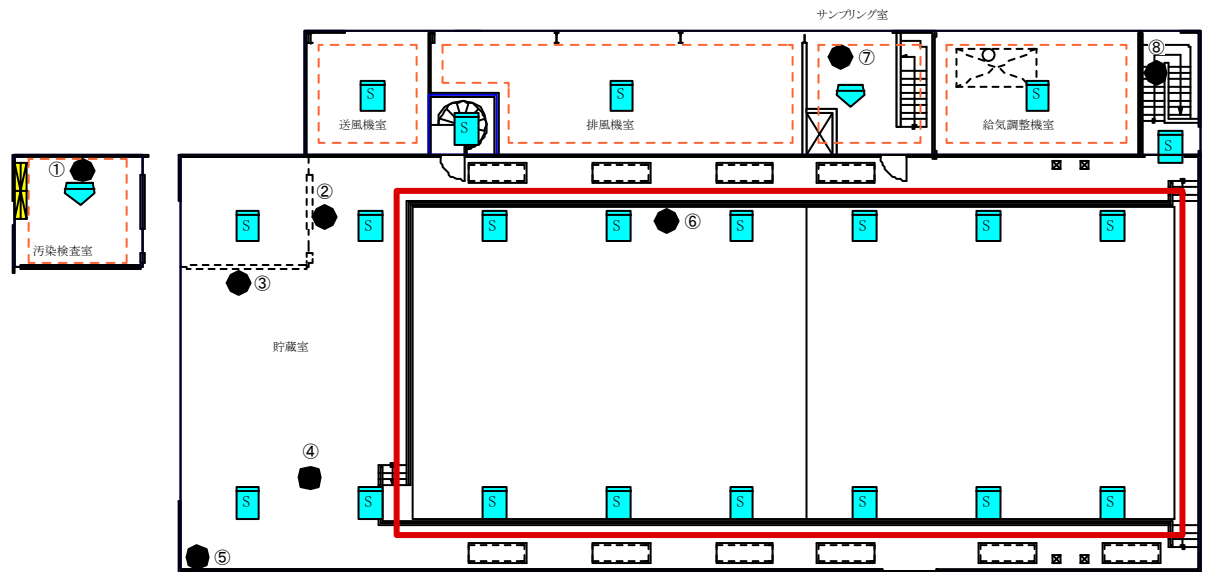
固体集積保管場Ⅳ平面図及び可燃物配置図
